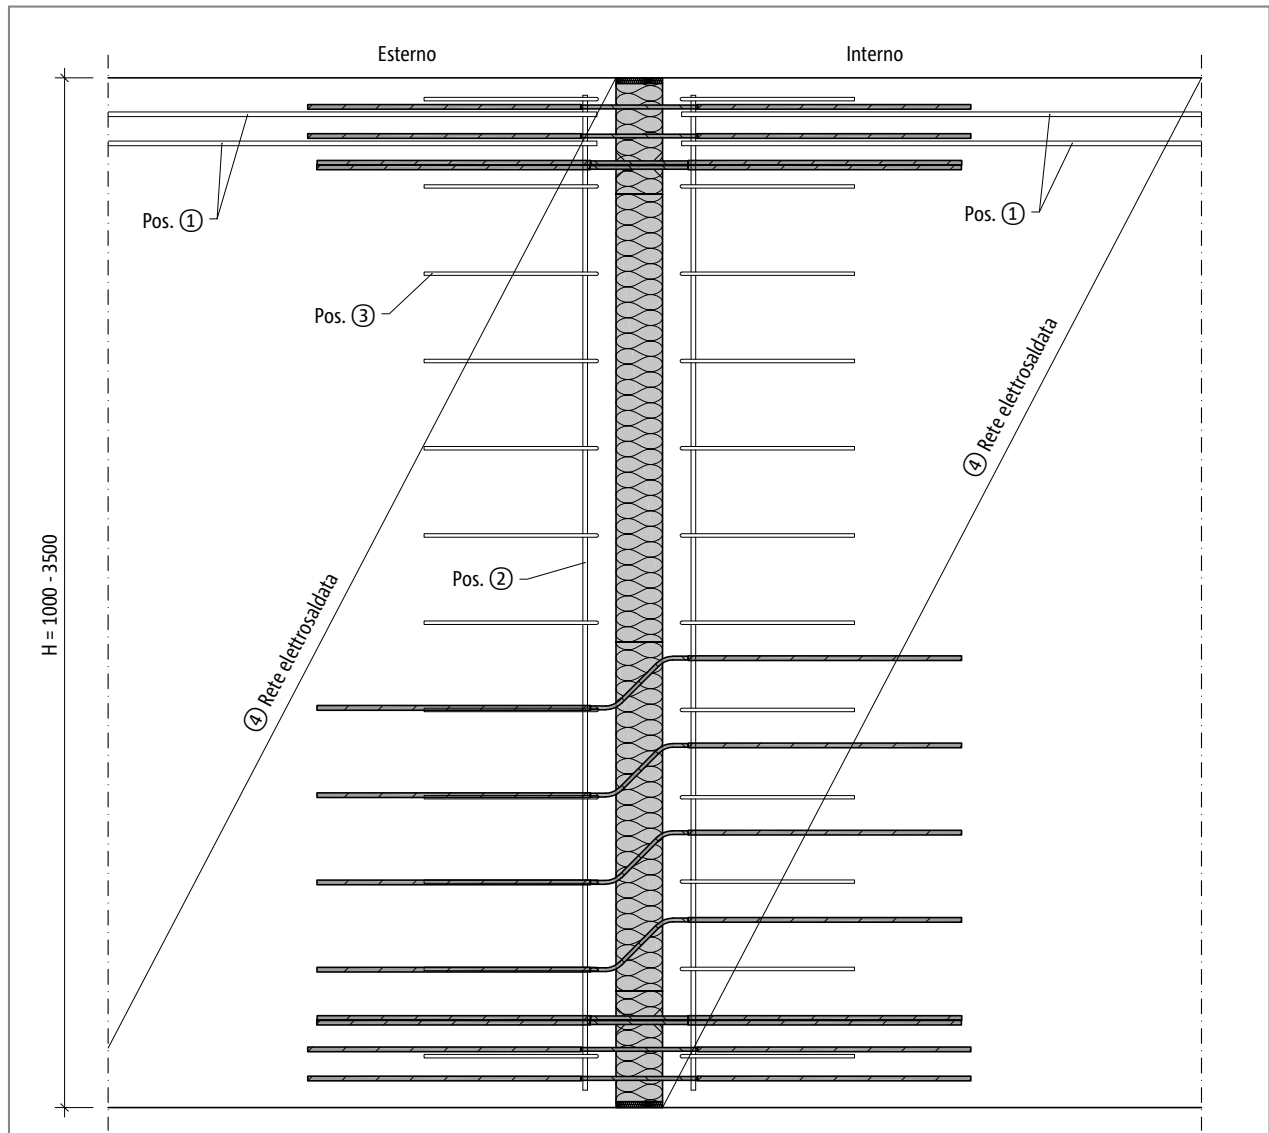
Schöck Isokorb® T tipo WL: armatura in opera; sezione
